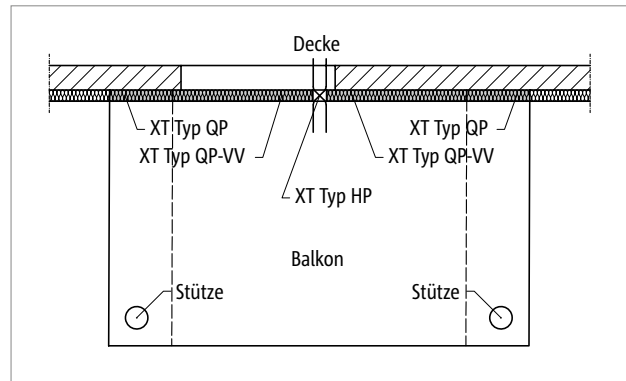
Schöck Isokorb® XT Typ QP, QL-VV: Balkon mit Stützenlagerung bei unterschiedlichen Auflagersteifigkeiten; optional mit XT Typ HP zur Übertragung planmäßiger Horizontalkraft
